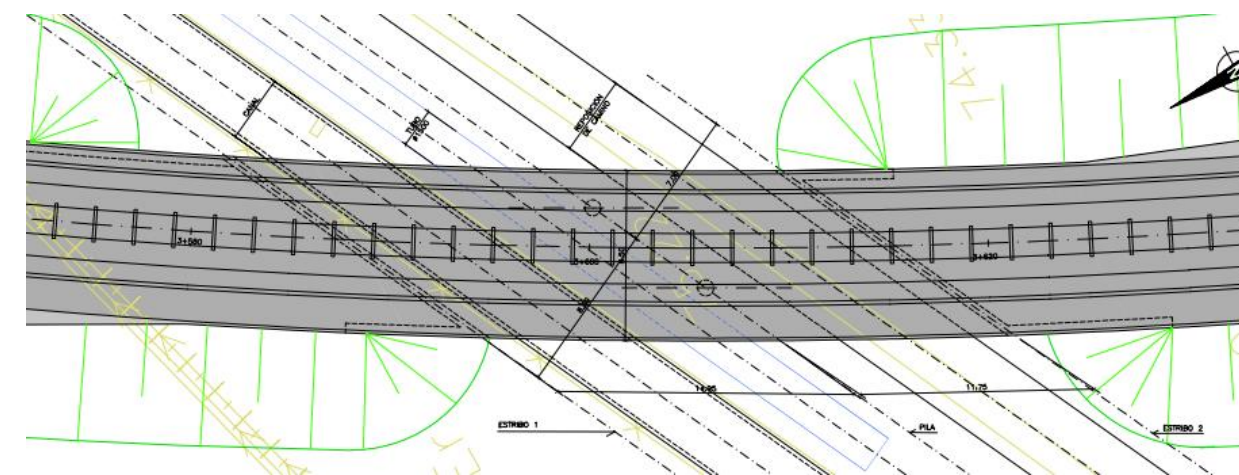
PLANTA PI TERCER CANAL DE RIEGO DE LEVANTE Y CAMINO P.K. 3+600
